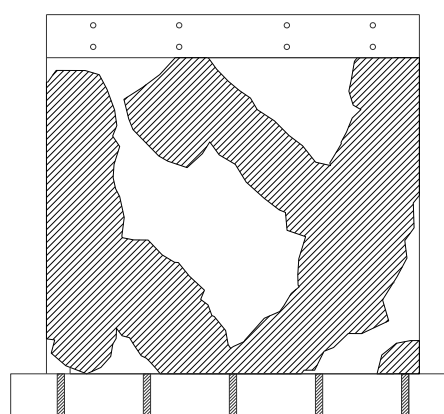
Agrietamiento de muro de albañilería confinada con ladrillos sólido artesanal en la distorsión 1/1000.
